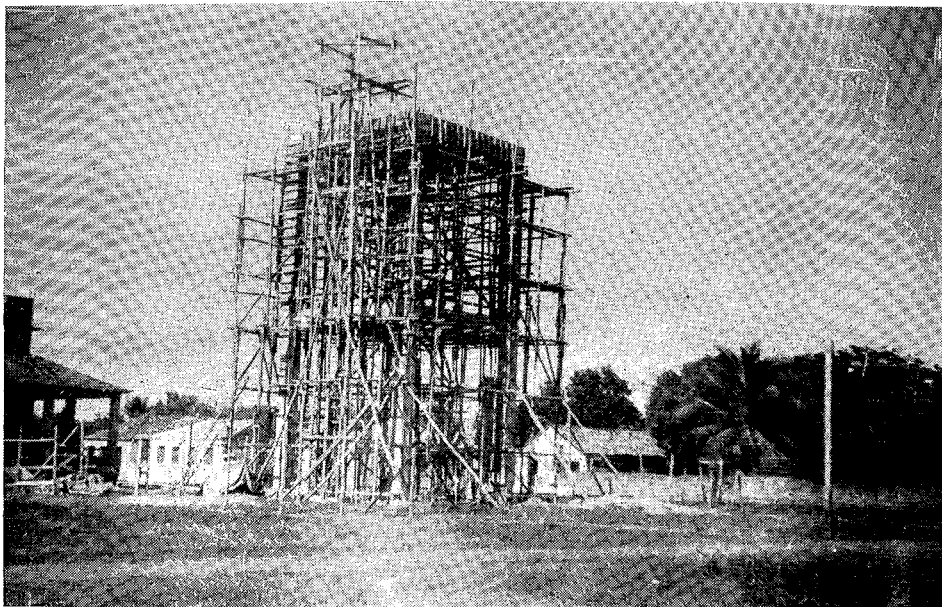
Aspecto da construção da grande cisterna na cidade, que fará futuramente o abastecimento da água para Marabá
